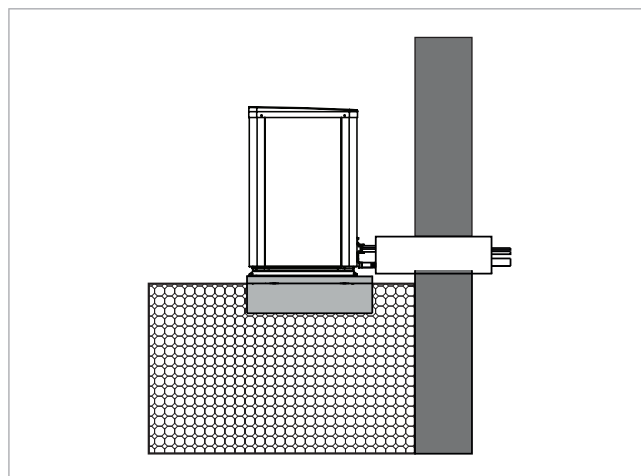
Wanddurchführung oberirdisch, SolvisPia
